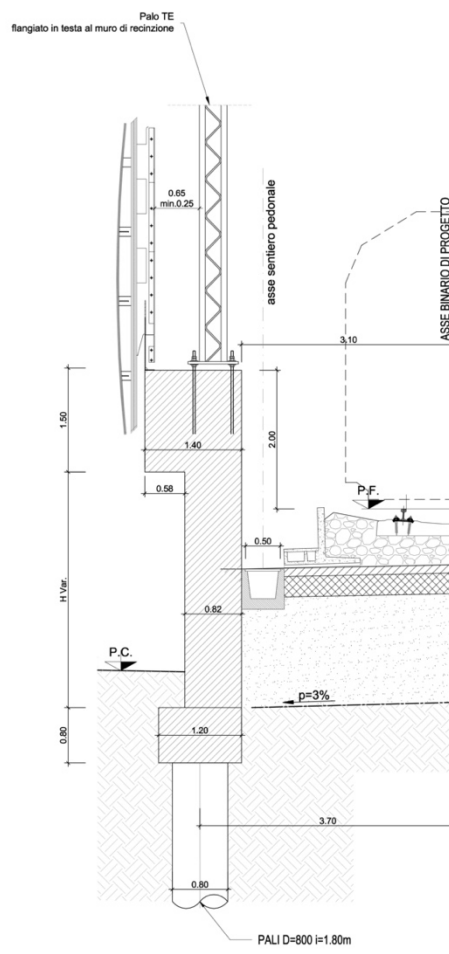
Sezione tipo: Sezione Stretta – TIPO 1
